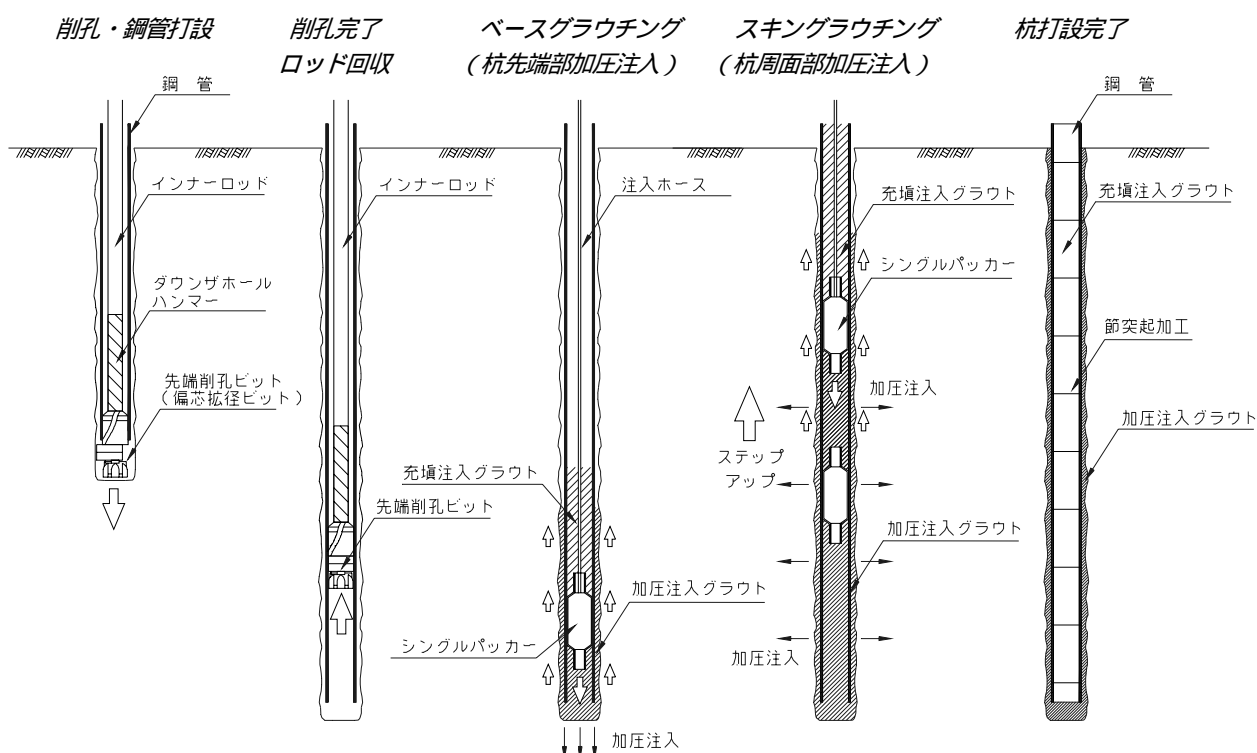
ST マイクロパイル タイプ の標準的な施工手順
